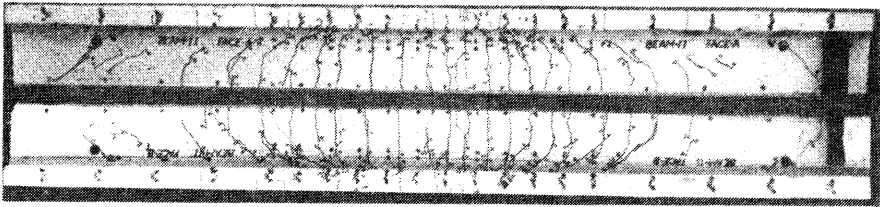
Retak lentur pada balok bertulangan banyak. (Tes oleh Nawy, Potyondy, dkk.)
